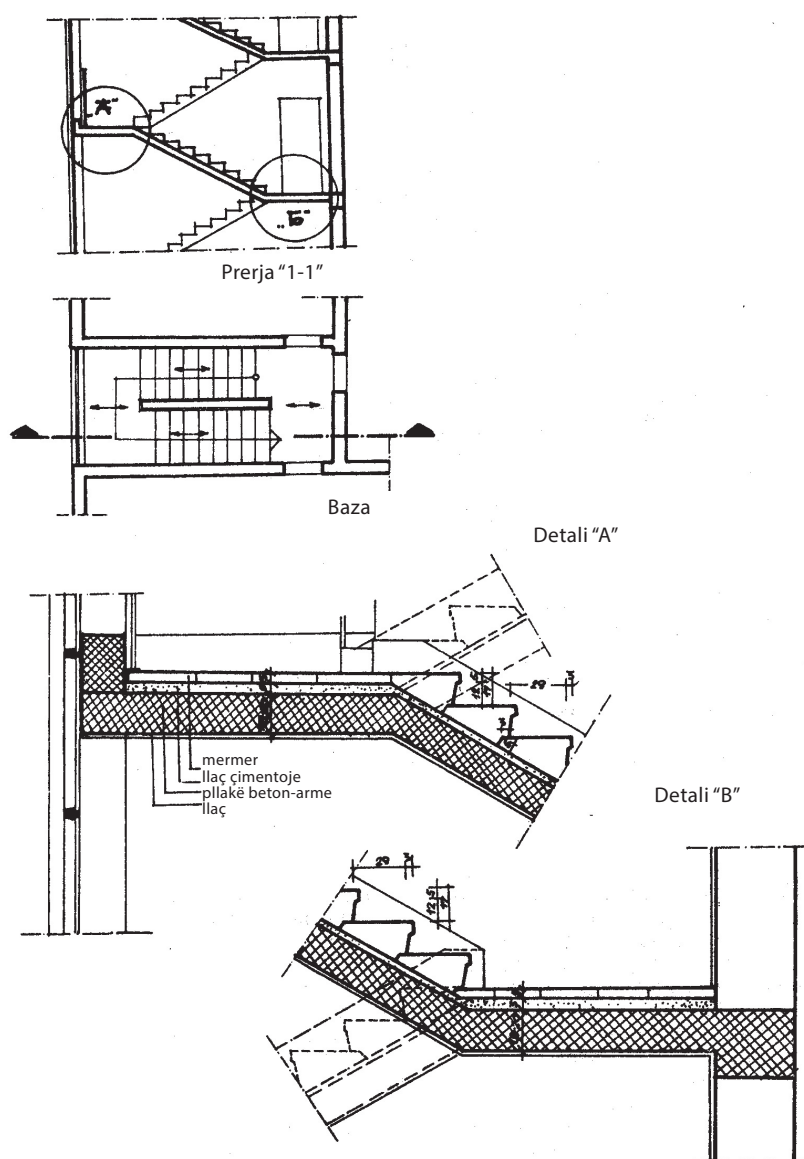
Shkallare në pllakë me beton-arme në formë gjuri
